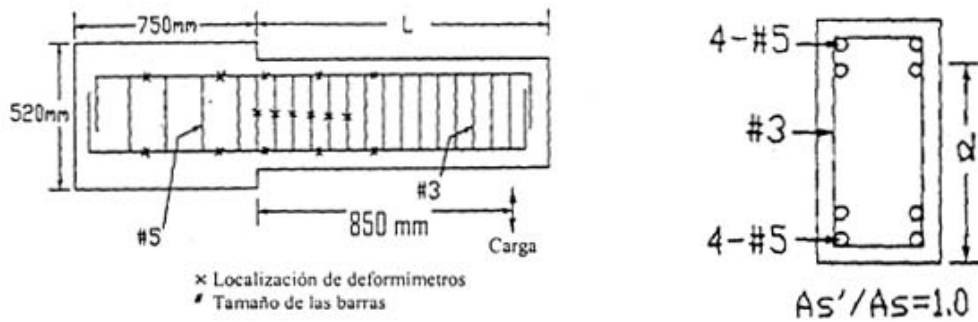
Geometría de la estructura y detalles de la sección transversal del elemento de viga del ensayo lb2-4 realizado por Fang et. al. [46]
